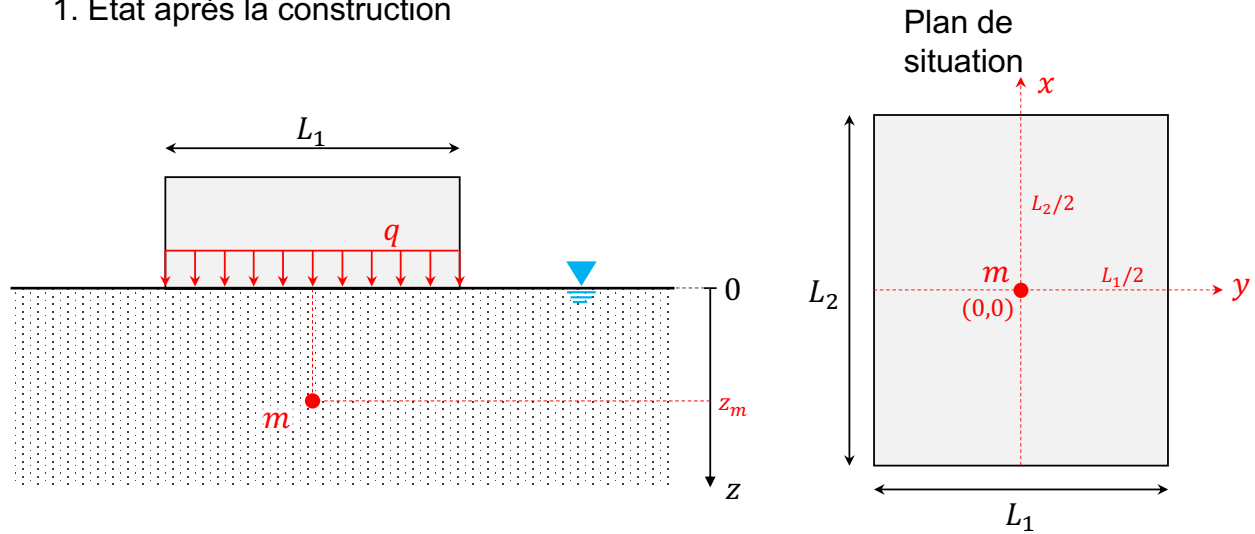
État 1 avec la construction du bâtiment. À gauche la coupe vertical et à droite le plan de situation.
